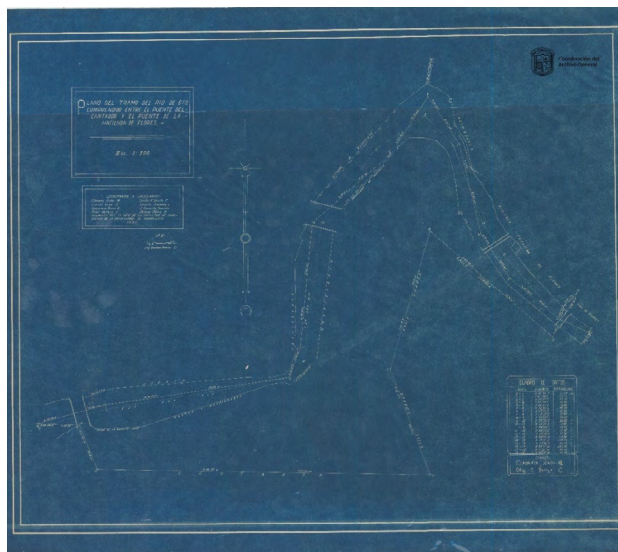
Plano del tramo del río Guanajuato comprendido entre el Puente del Cantador y el Puente de la Hacienda de Flores, AHUG, Fondo Andrés Nieto Vargas, R.6, Plano 2, 1951.
